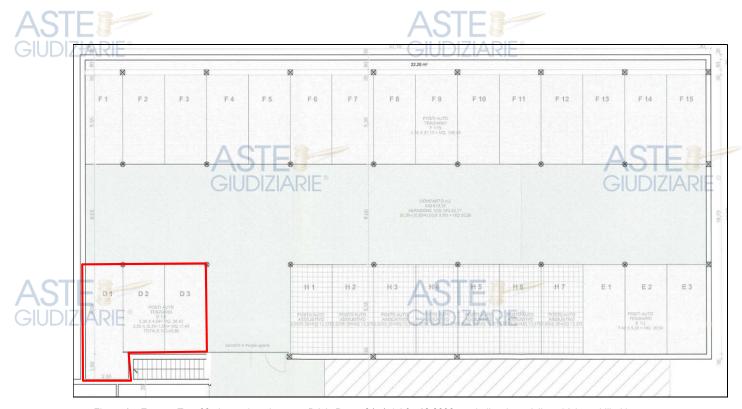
Estratto Tav. 03 pianta piano interrato D.I.A. Prot. 52454 del 05.12.2006 con indicazione delle unità immobiliari in oggetto
